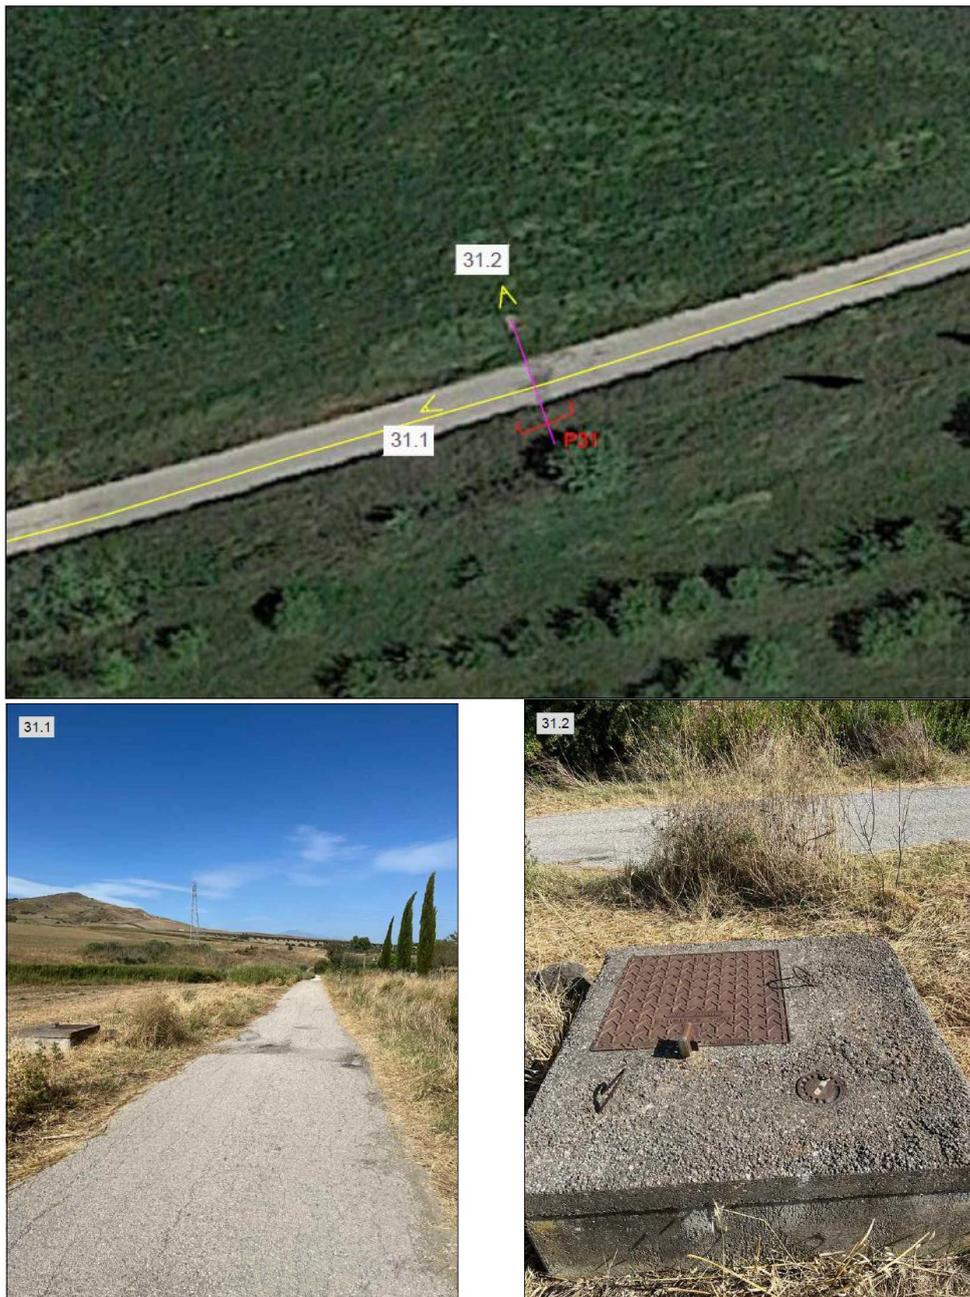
Attraversamento su strada di tubazione irrigua – Stralcio su ortofoto e foto
